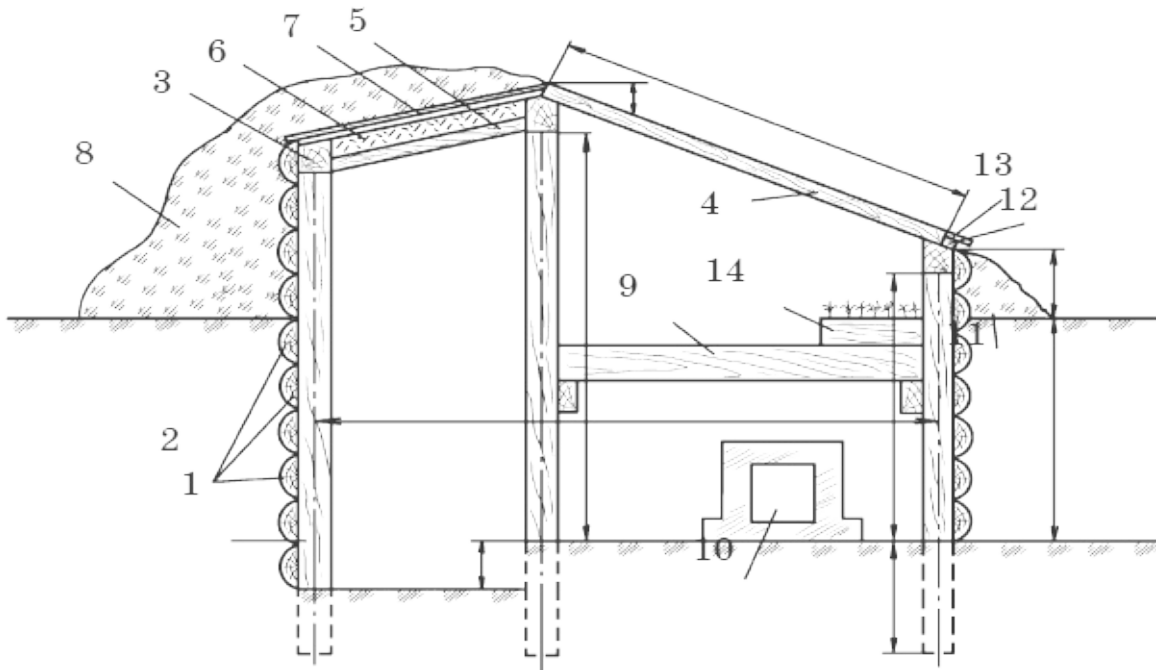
Зимняя односкатная теплица: 1 — столбы; 2 — обшивка; 3 — обвязка; 4 — парниковая рама; 5 — доска; 6 — опилки; 7 — толь; 8 — земляная отсыпка; 9 — стеллаж; 10 — дымоход; 11 — откос; 12 — упорная доска; 13 — отлив; 14 — ящики с рассадой
